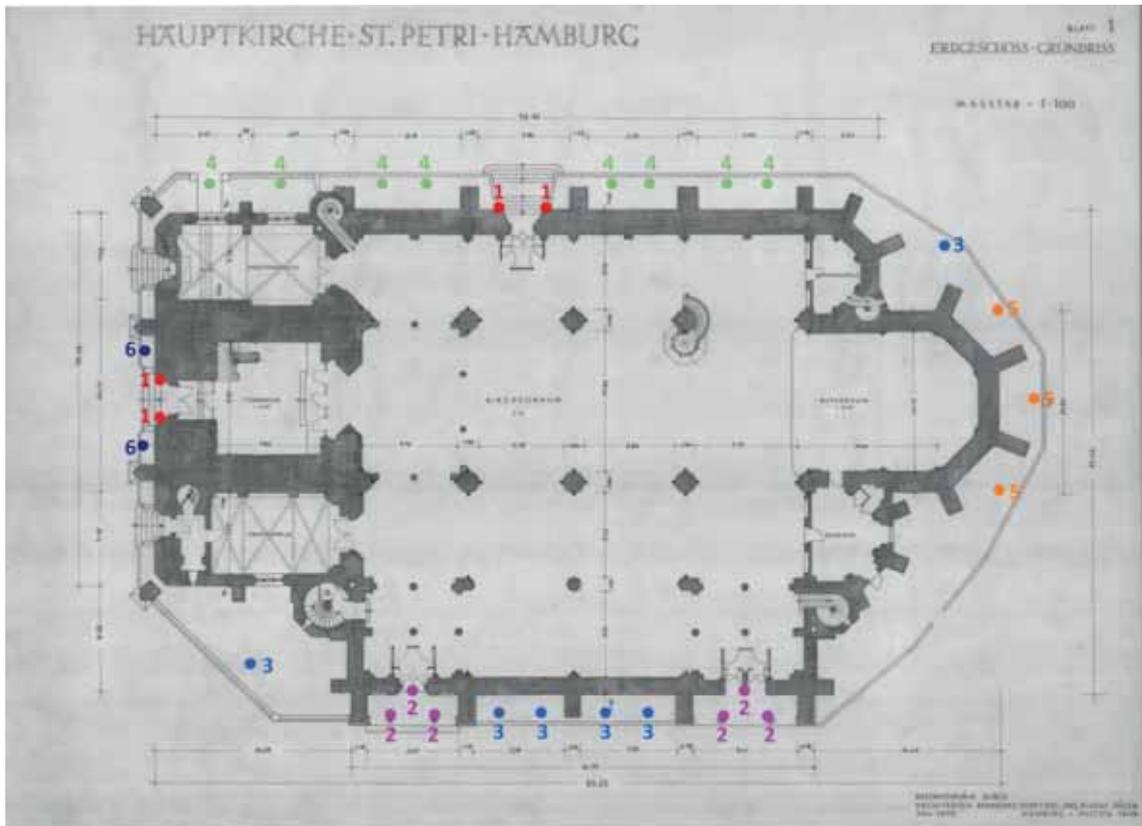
Übersicht der Leuchtenstandorte der Fassaden- und Eingangsbeleuchtung eingezeichnet in Grundrissplan der St. Petri Kirche [KKHHOst2012] (eigene Abbildung)
